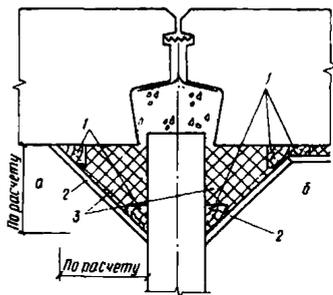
Утепление промерзающих стыков без утепления (а) и с утеплением (б) наружной стены
